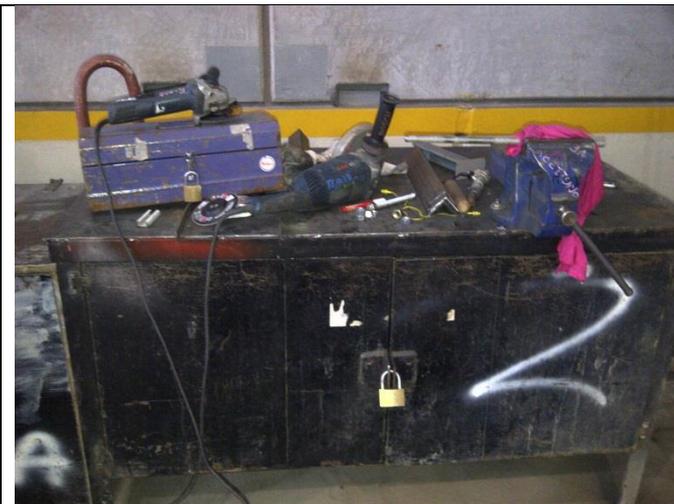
Amoladoras colocadas de forma incorrecta.
